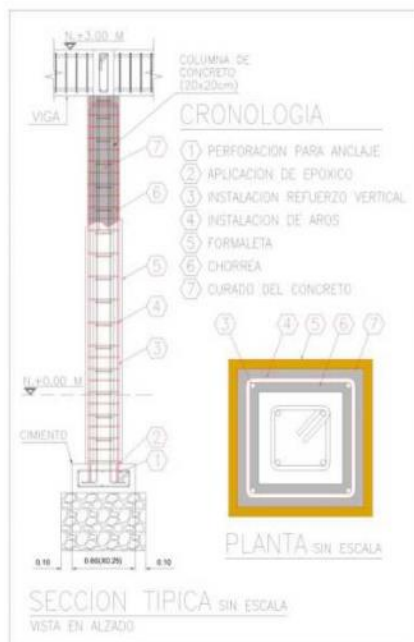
Vista en alzado de la columna con refuerzo por anillo perimetral.
